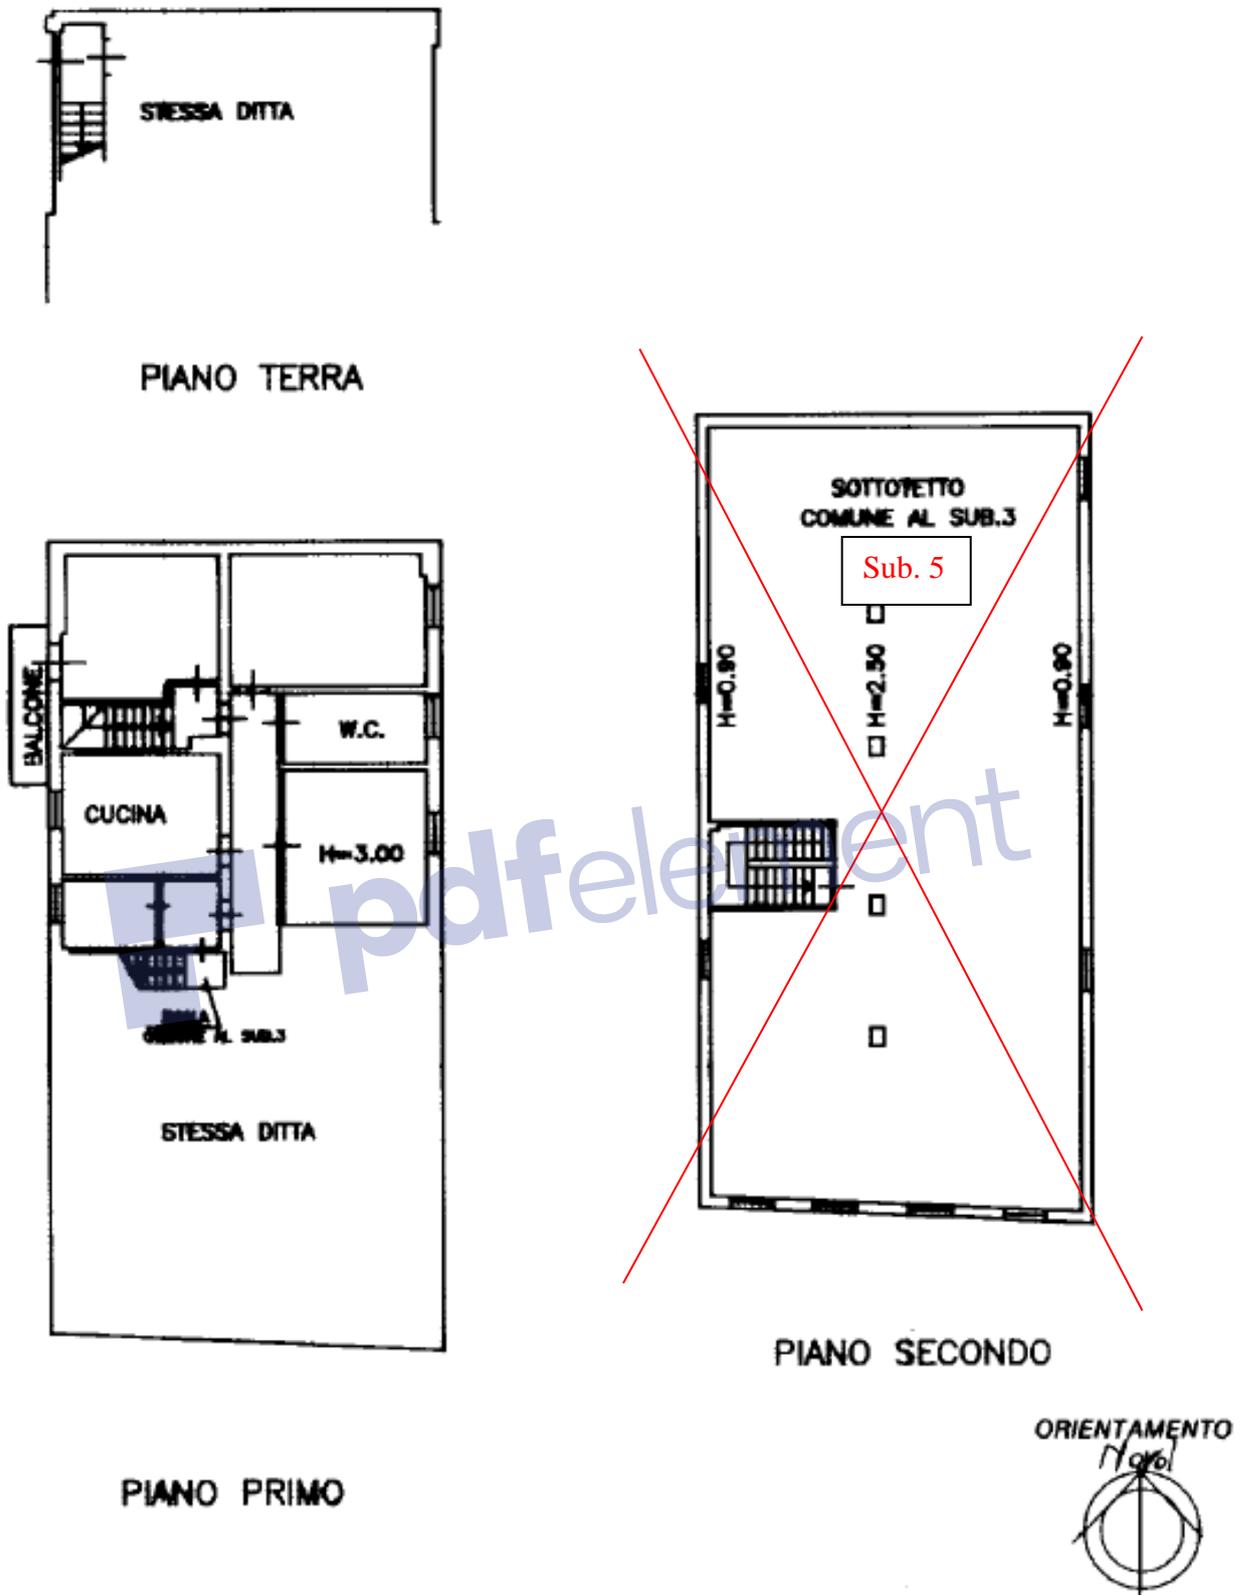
Planimetria catastale sub. 4 – LOTTO 1
